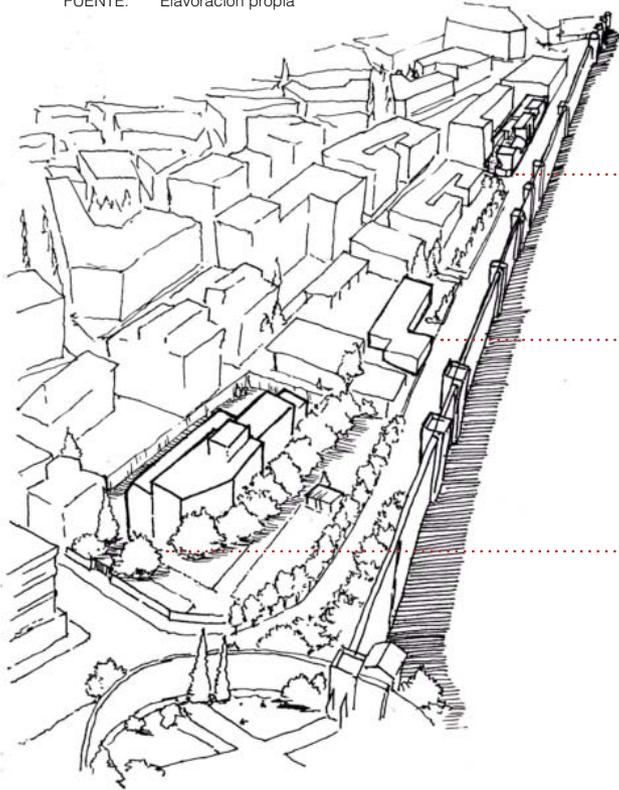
Fachada Muro Aureliano, proyecto C.I.R.C.O.
